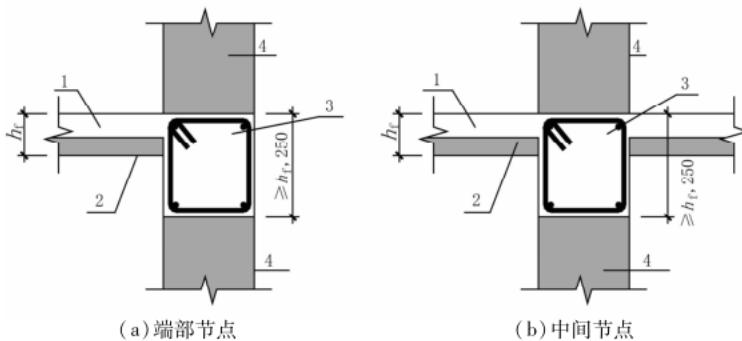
后浇钢筋混凝土圈梁构造示意
